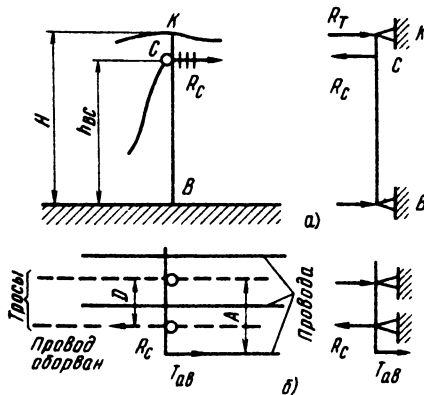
Статическая схема к расчету дополнительного тяжения по тросу при обрыве провода одной фазы
